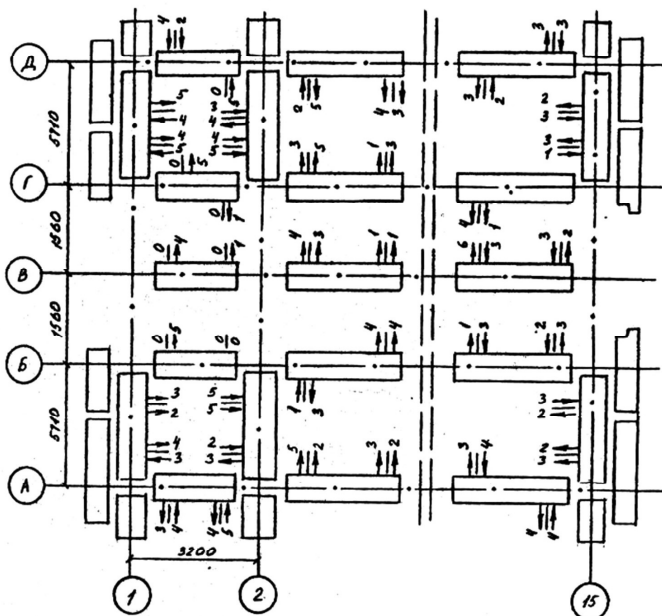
Исполнительная схема панелей стен и перегородок
